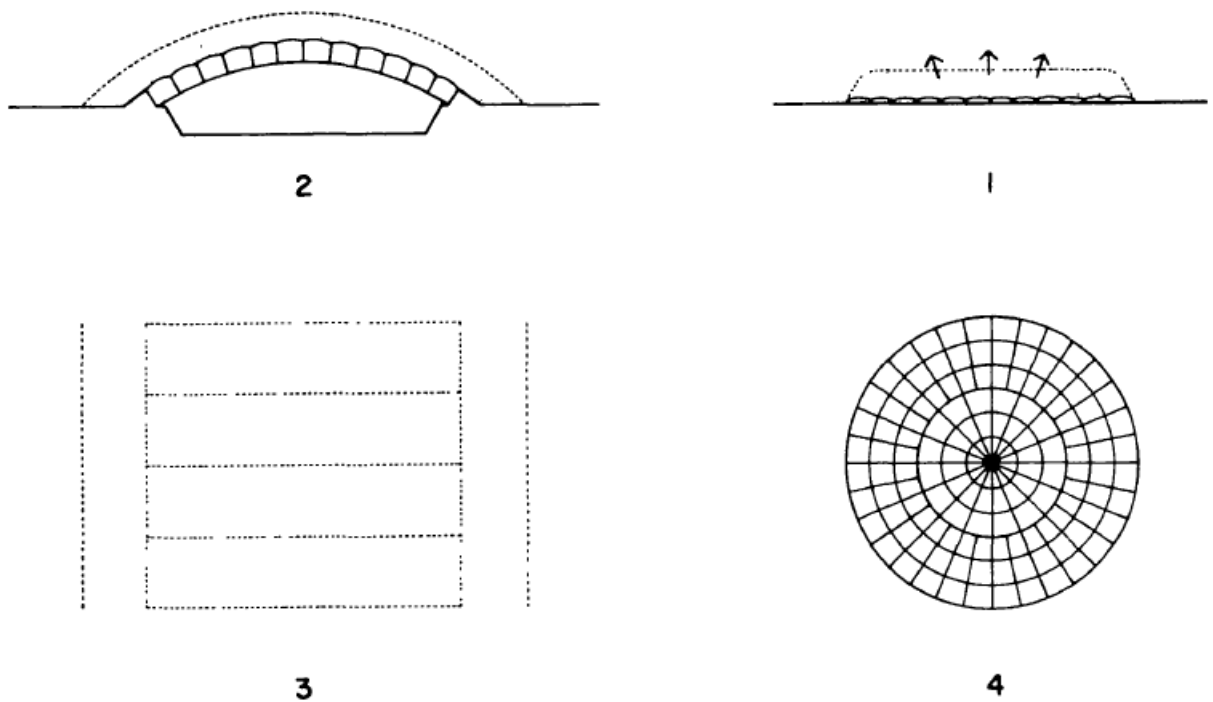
Арочний щит з пневматичною опорною конструкцією
